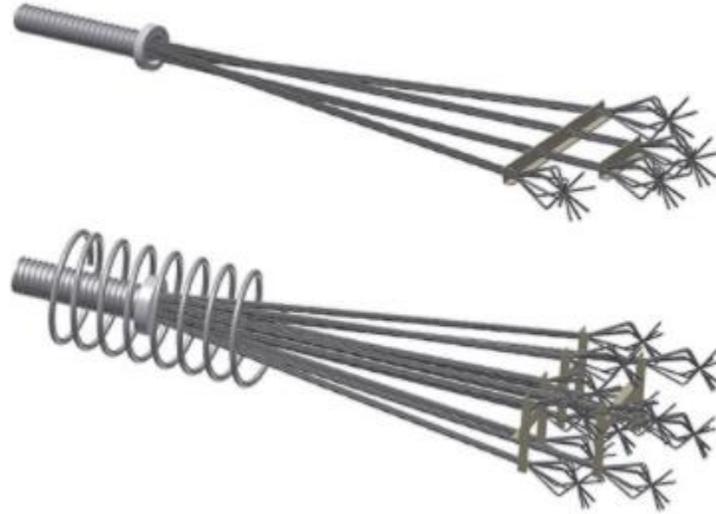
Anclajes pasivos por adherencia. Obtenido en: <https://civildigital.com/anchorage-systems-post-tensioning-types-prestressed-concrete-anchorage-images/>
